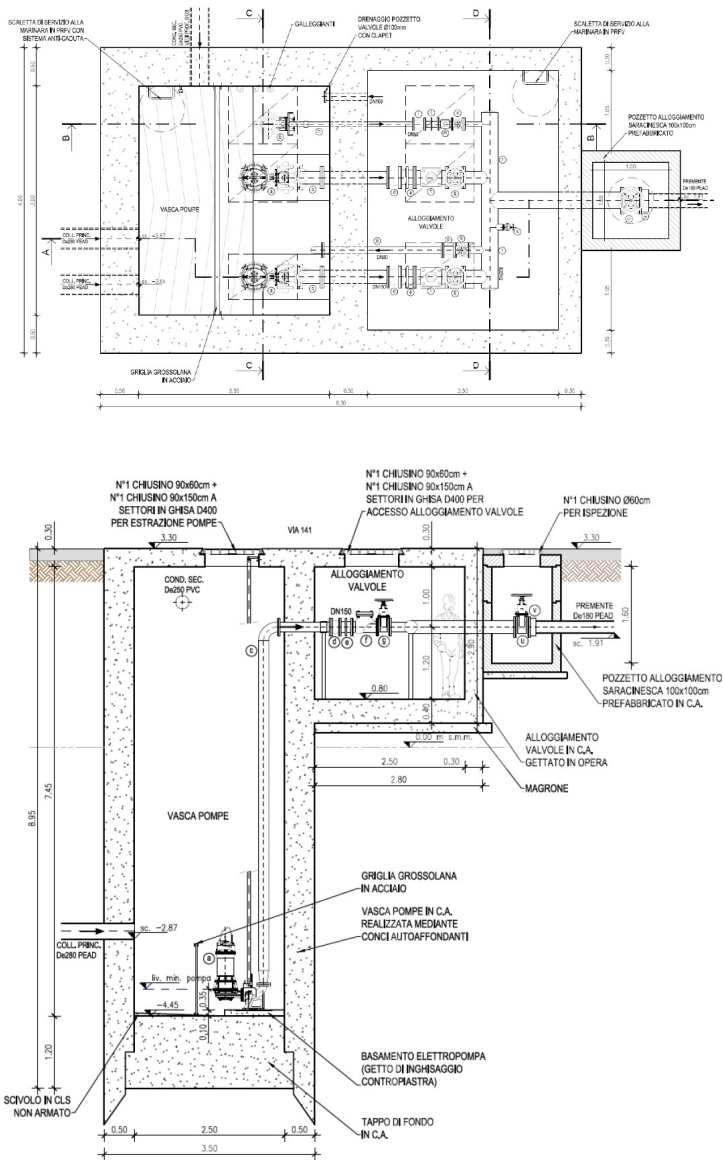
Pianta e sezioni impianto di sollevamento S9
